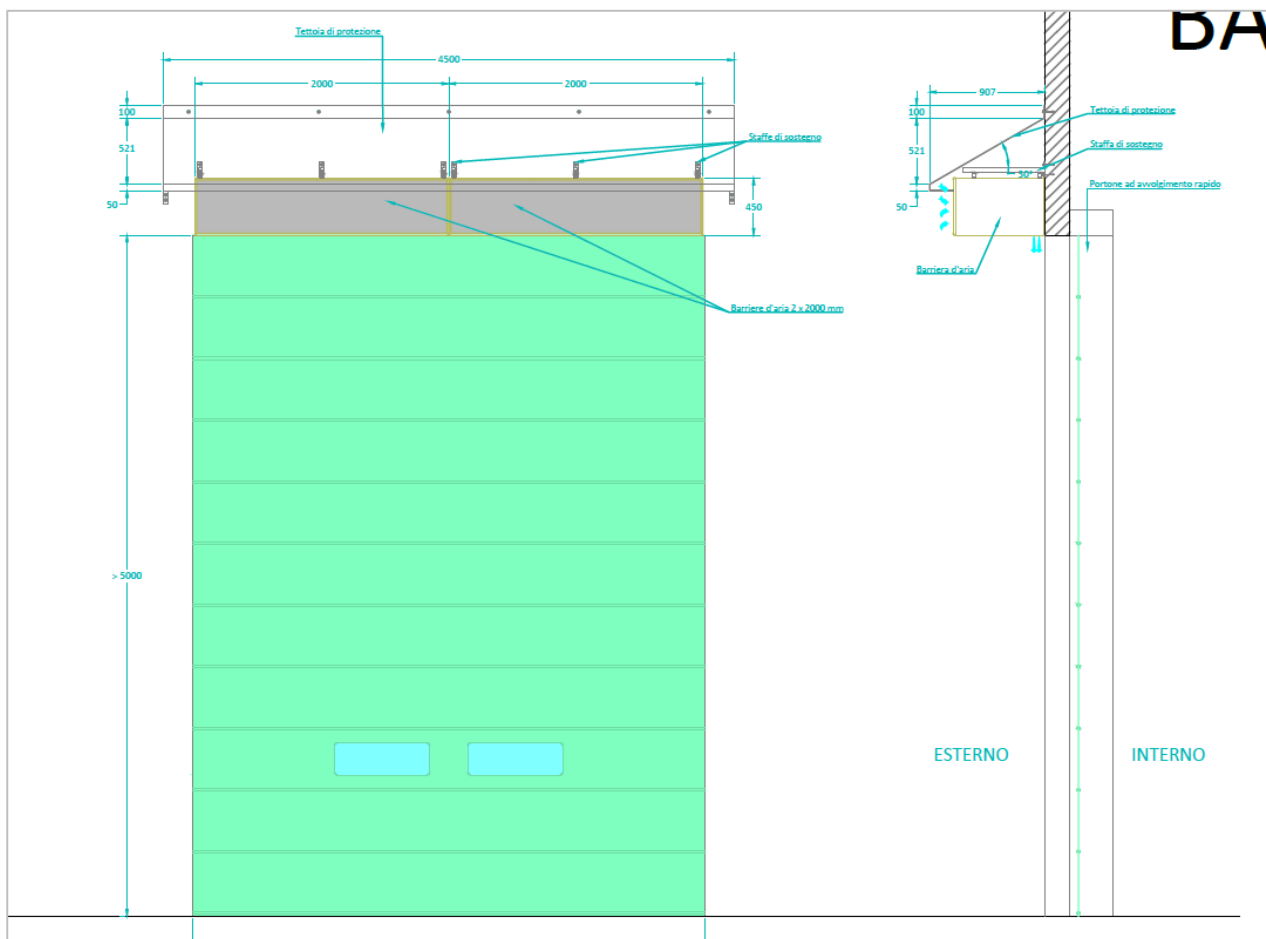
Schema in prospettiva e sezione del sistema barriera d'aria in fase di portone chiuso.
